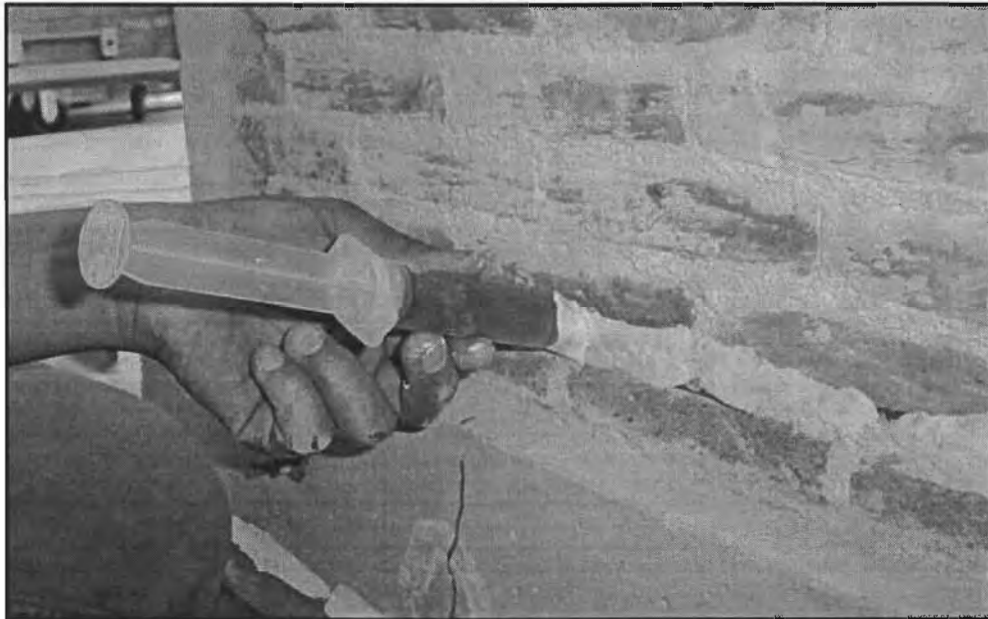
Reparación de grietas previas al ensayo
